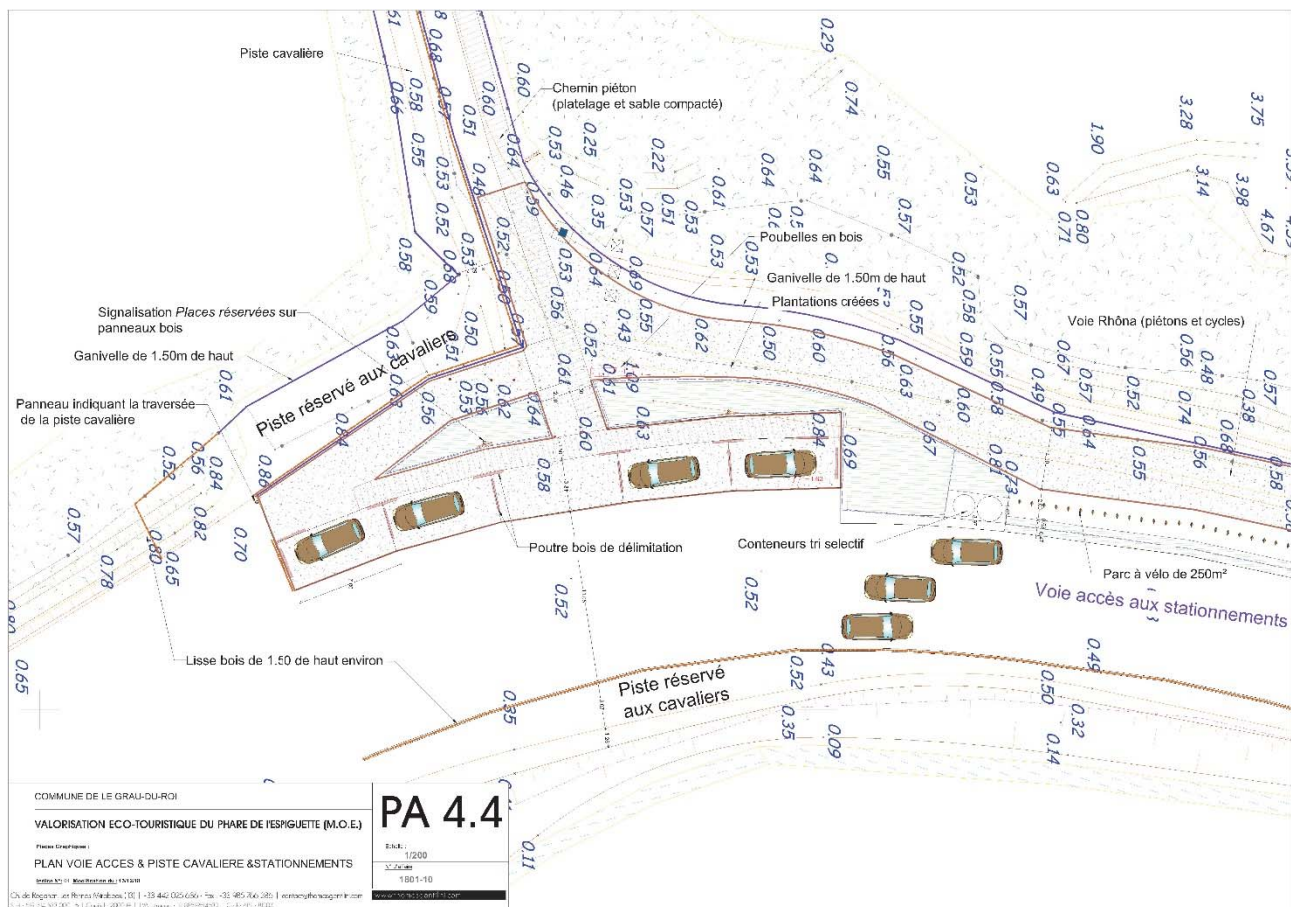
Plan d'aménagement de l'accès au chemin de la plage
